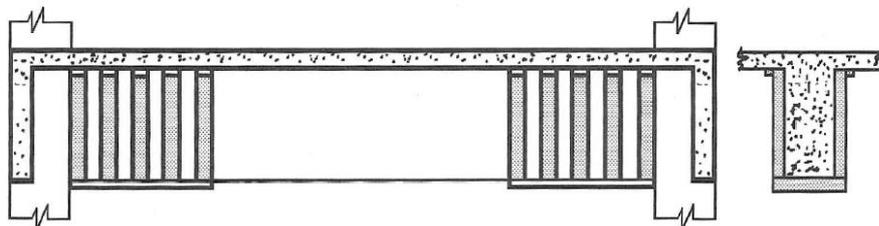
Reforço de viga de concreto ao cisalhamento através de chapas coladas.
